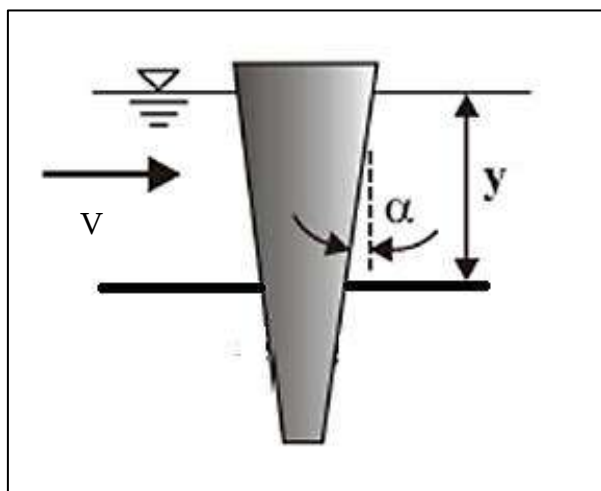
13 Vista lateral de pilar con estrechamiento hacia abajo.
